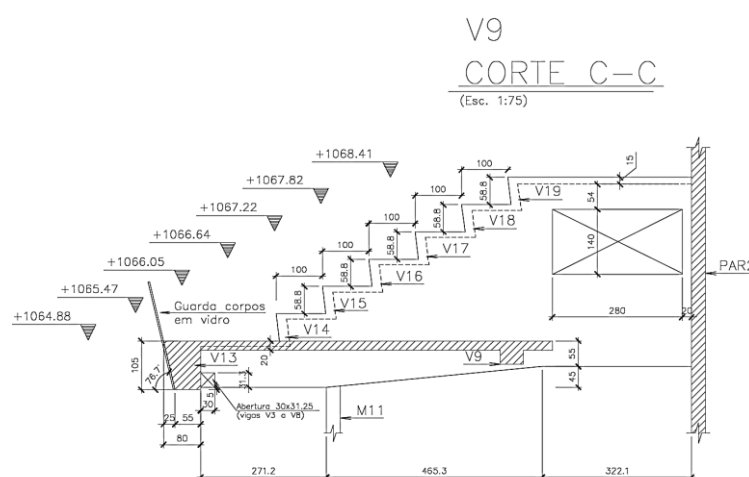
Corte das viga de topo da arquibancada com abertura retangular
